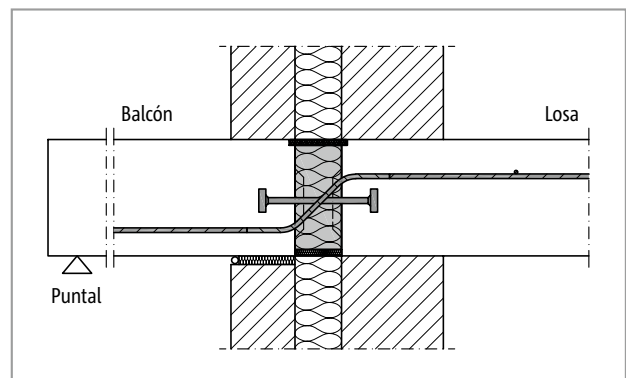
Schöck Isokorb® T tipo Q-P: Conexión del balcón apoyado en caso de muro doble con núcleo aislante
